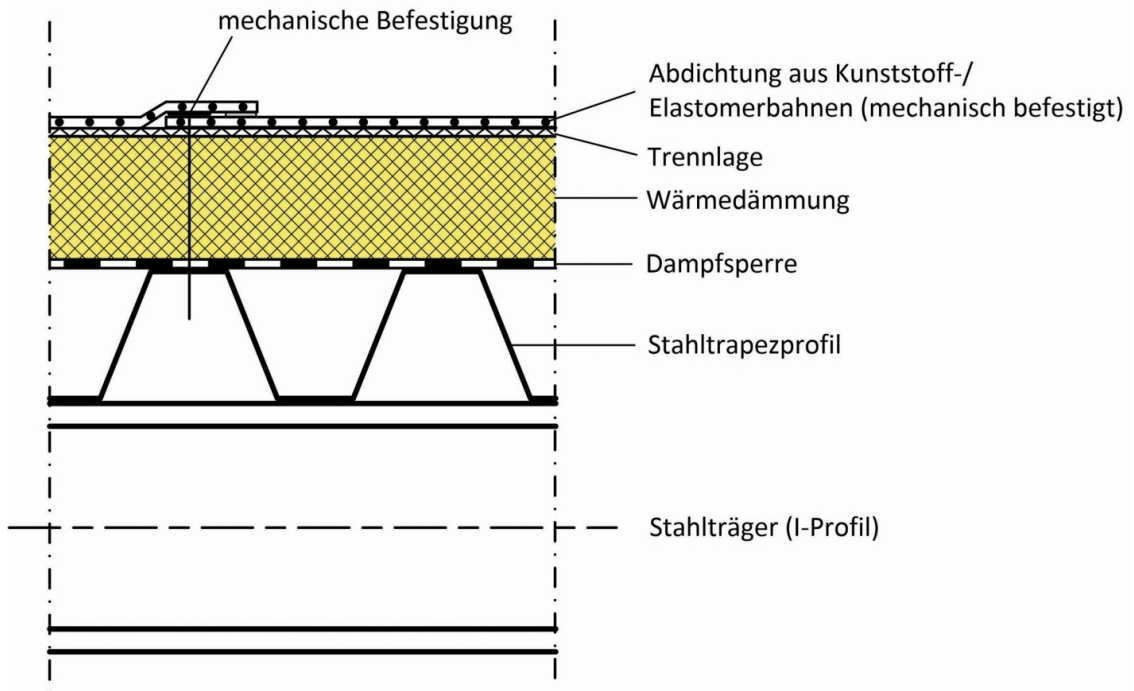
Nicht belüftetes Dach als Konstruktion auf Stahltrapezprofilen (Quelle: Schmidt)
